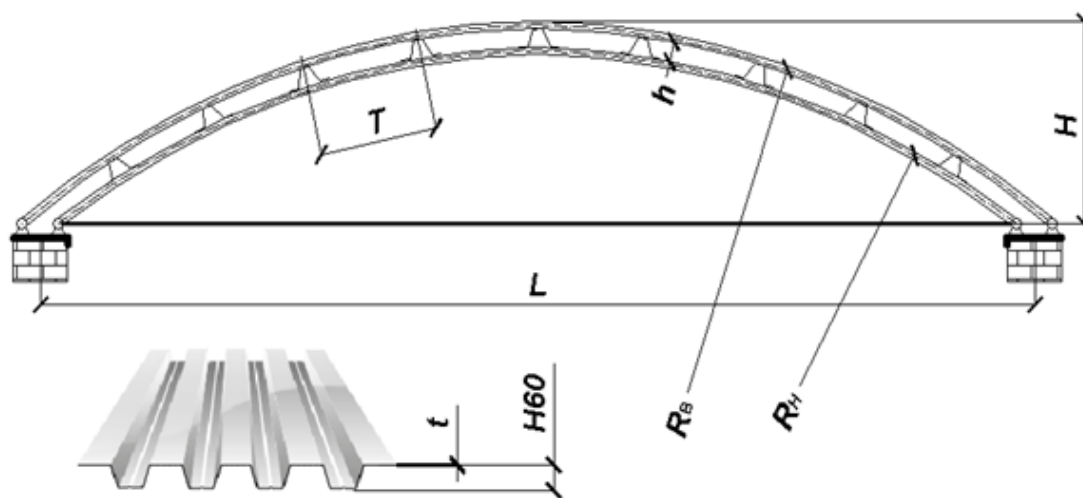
Схема двухслойного несущего арочного покрытия из тонколистового металлического профнастила
